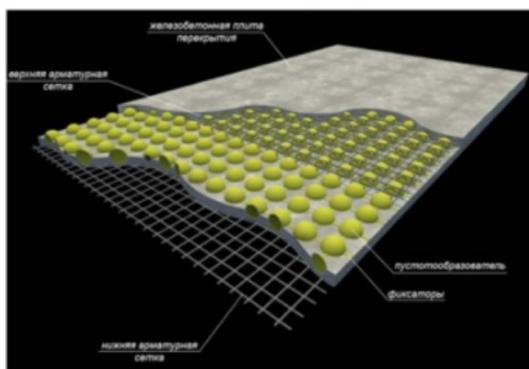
Конструктивное решение безбалочной железобетонной плиты перекрытия
